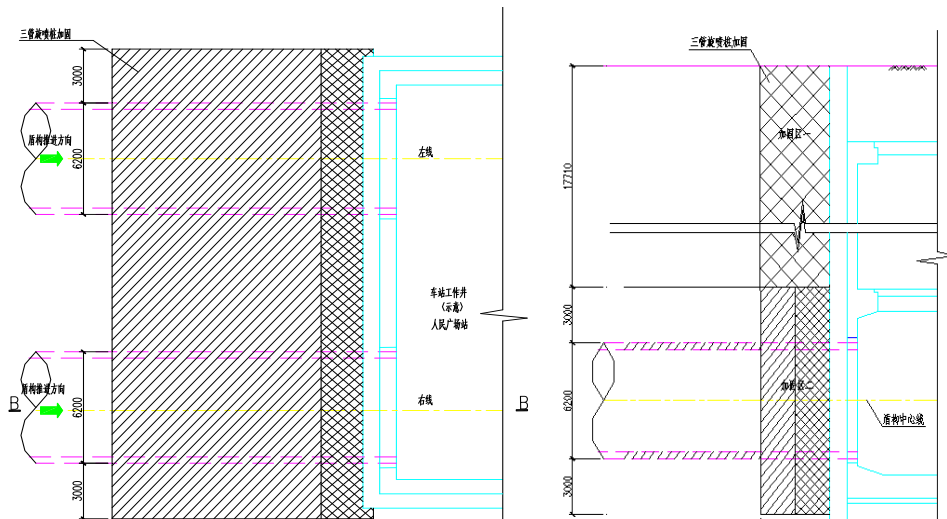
太人区间盾构接收端头加固平面及剖面图
